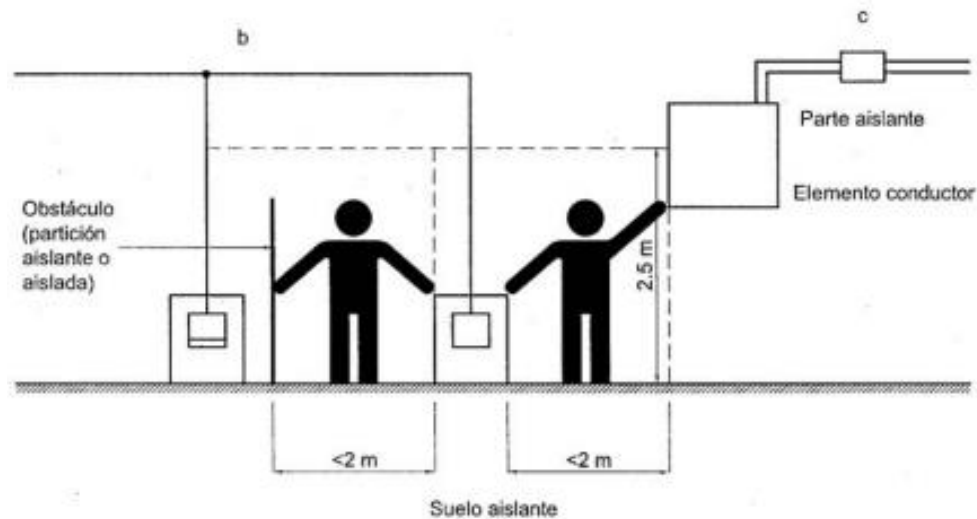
Ejemplo 2 de protección en locales o emplazamientos no conductores. [1]
